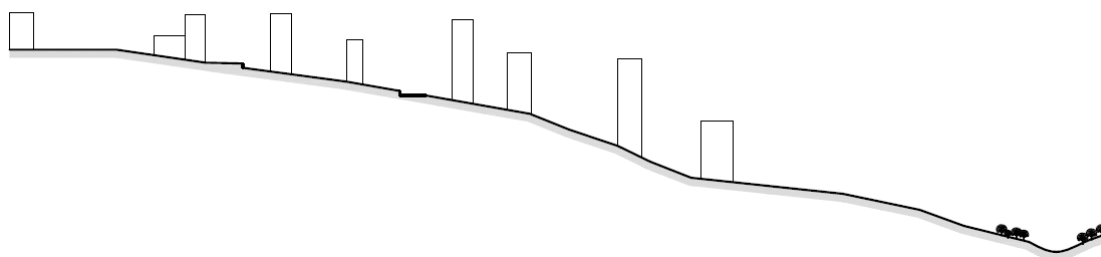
Perfil do bairro Vila da Serra- Sem escala.
